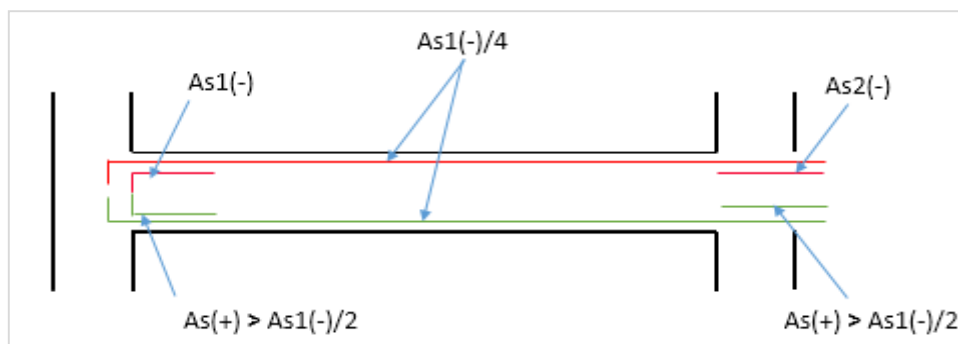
Distribución de refuerzo en viga según ACI 318-14. 18.6.3.2
